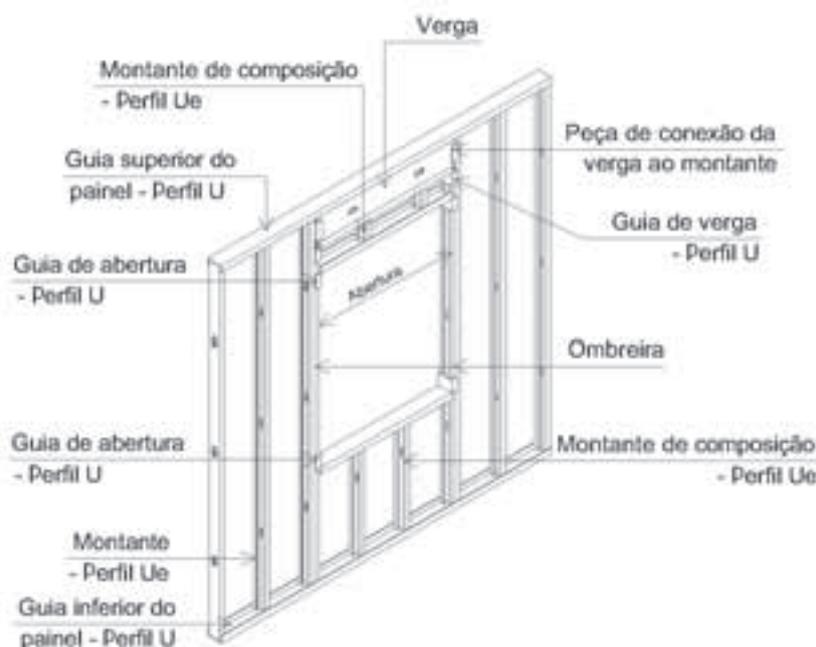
Desenho esquemático de painel estrutural com abertura
